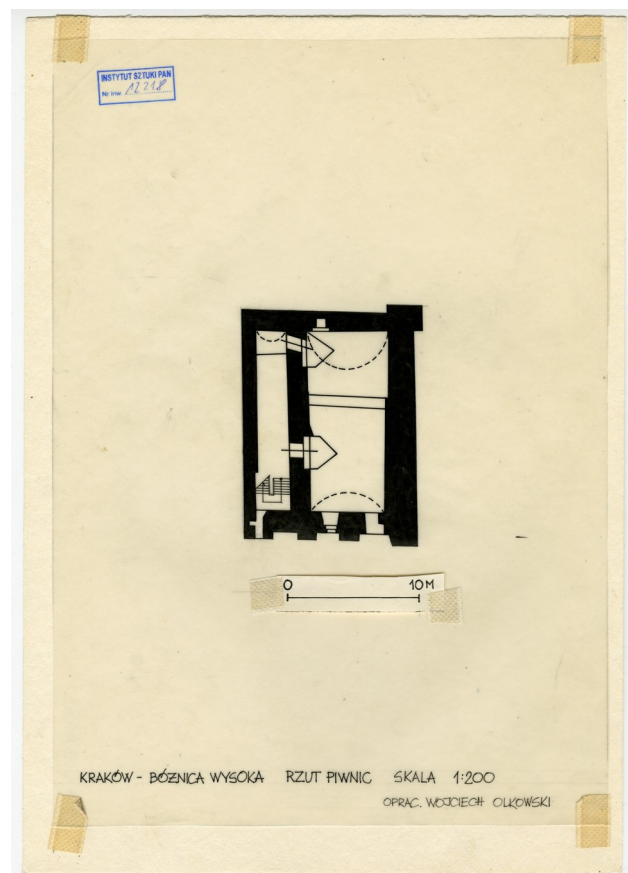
Grundriss KG, 1960er Jahre
